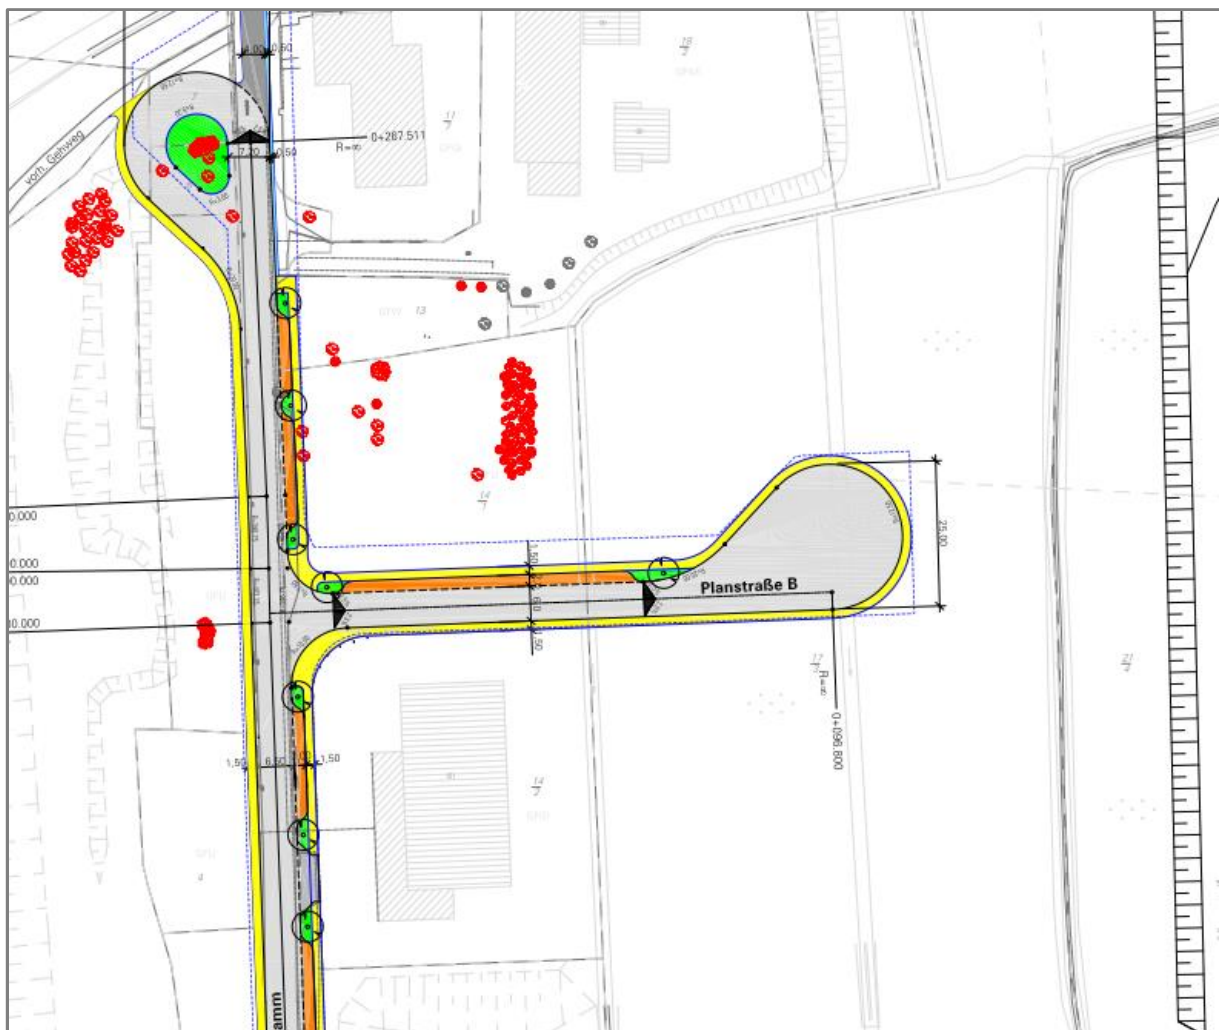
Erschließungsstraße – Stichstraße (Planstraße B) für den 3. Bauabschnitt [mit Baummarkierungen (rote Punkte)]
